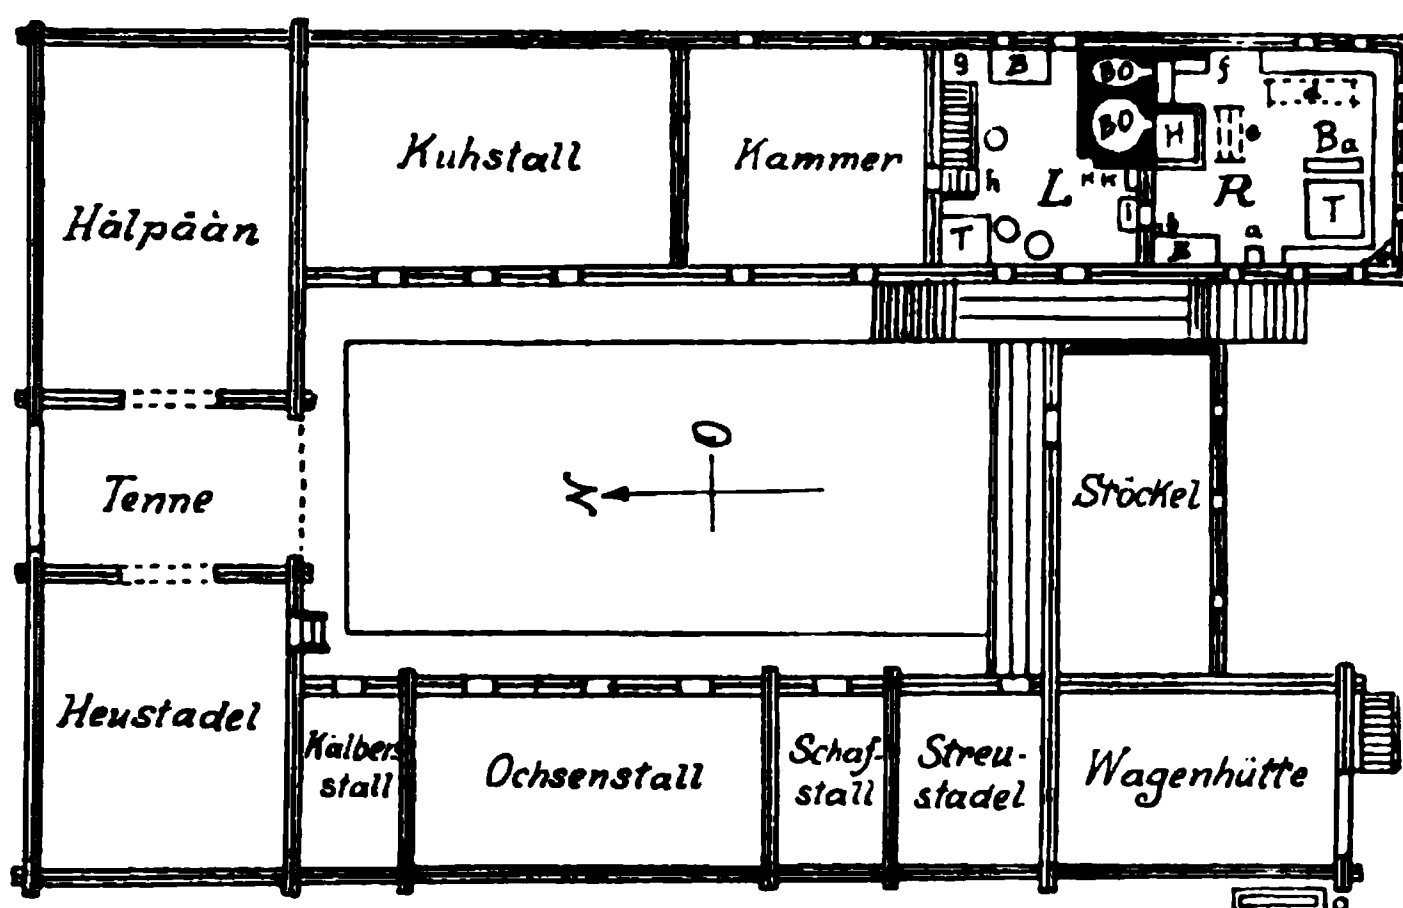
Grundriss des Hauses Nr. 84 in Riegersbach bei Vorau.
